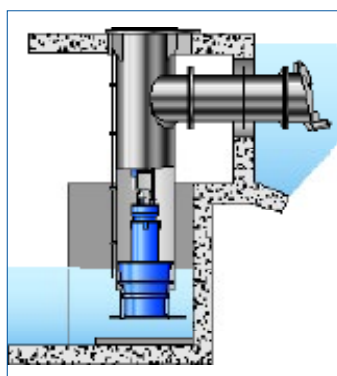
c : Variantes de tubes avec refoulement sous plan de pose
